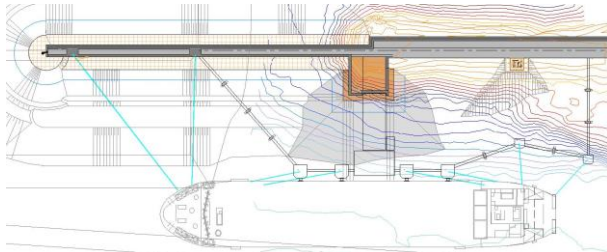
Planta del Nuevo Muelle Petrolero de Moín.
